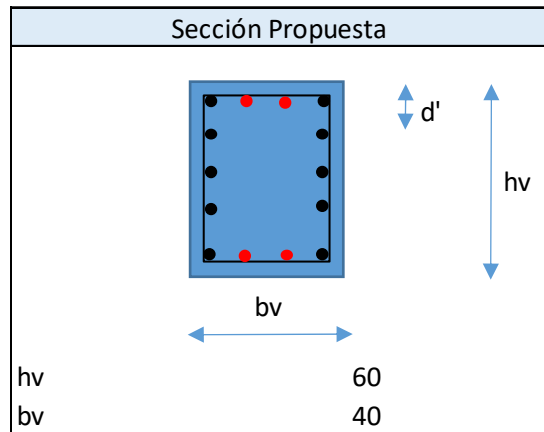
Vigas de cimentación medianeras ejes C1 y C4
